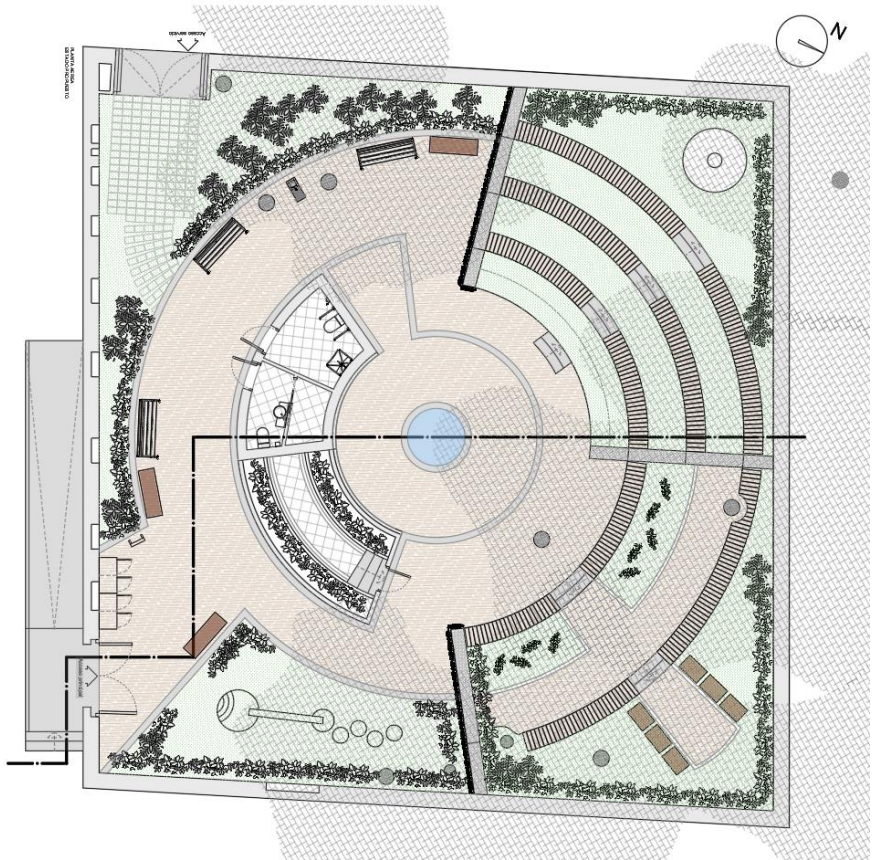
Esquema de planta estado reformado propuesto. Fuente propia.
